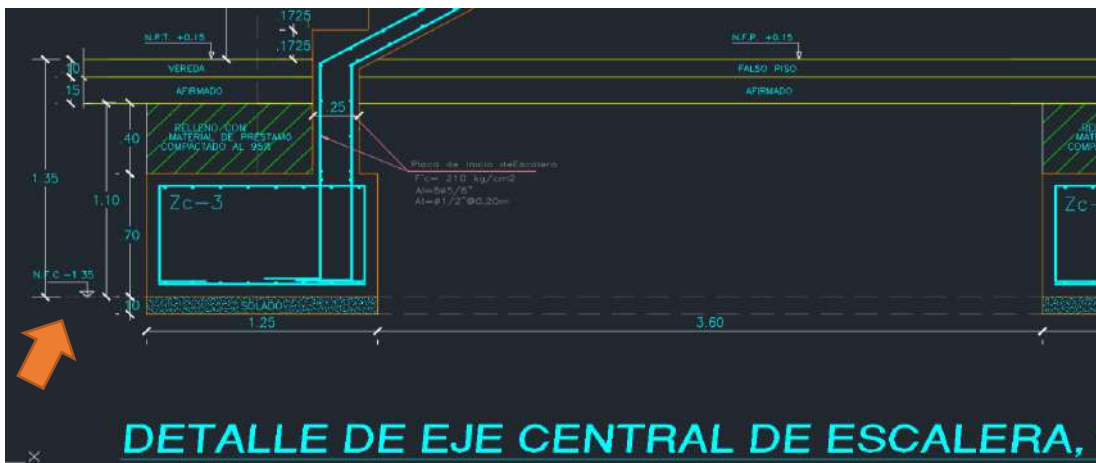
Incongruencia en Detalles estructurales de PL - 03.
